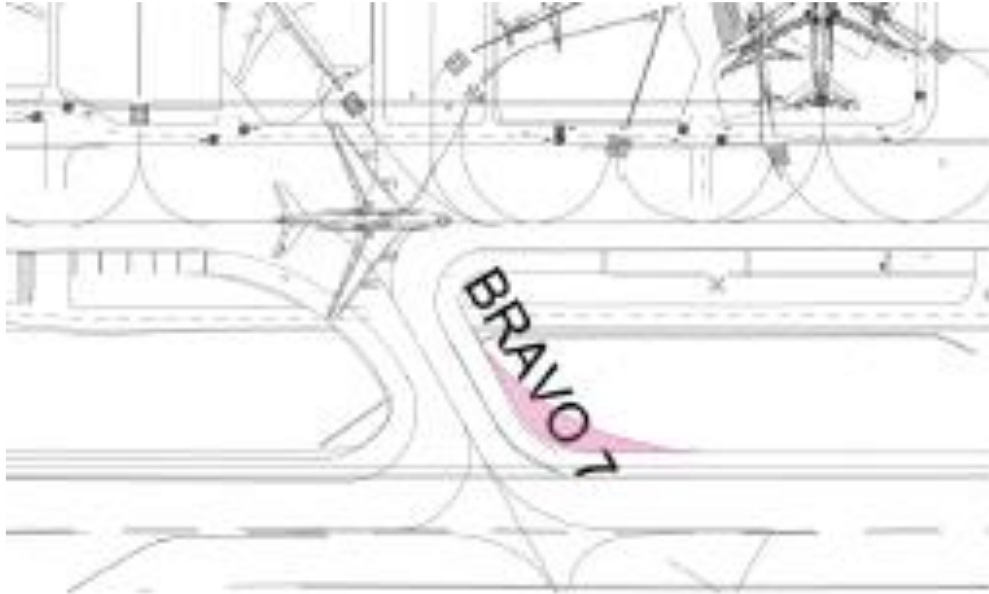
Construcción Fillet en Bravo 7 (\$5 MDP)
